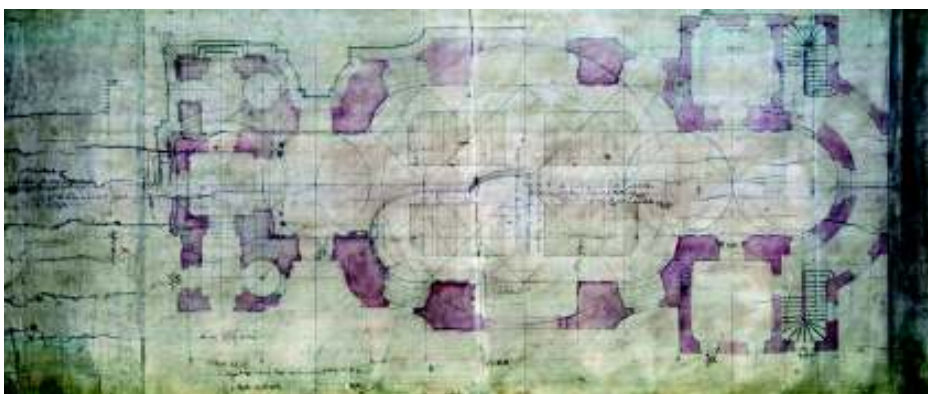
Plan original (înainte de 1769) – plan parter al bisericii Piariste din Carei
